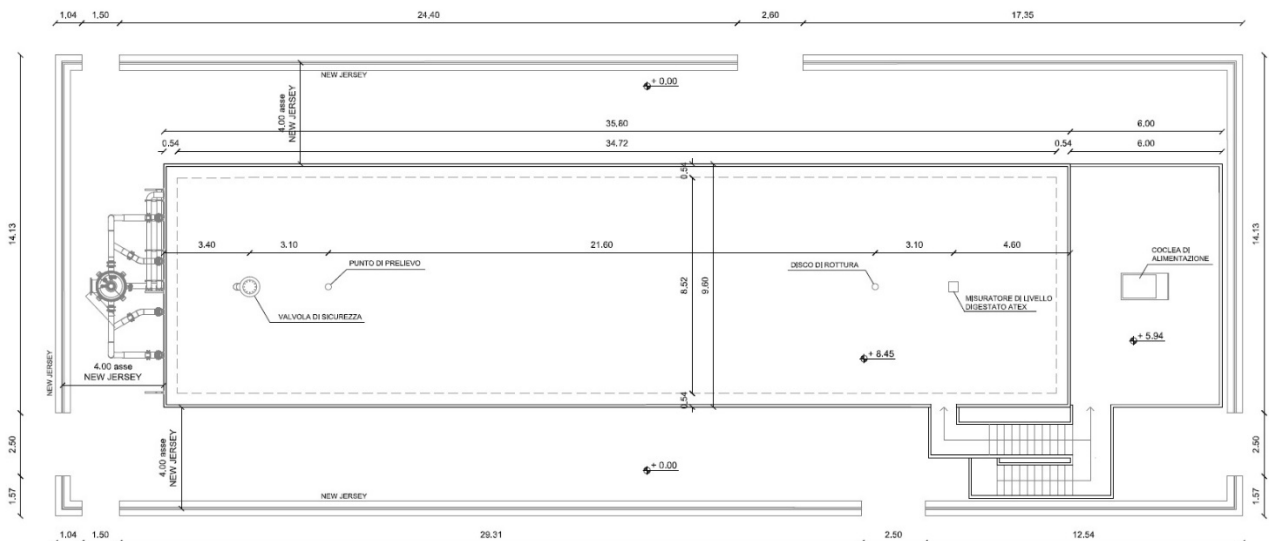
Planimetria della sezione di Digestione Anaerobica
